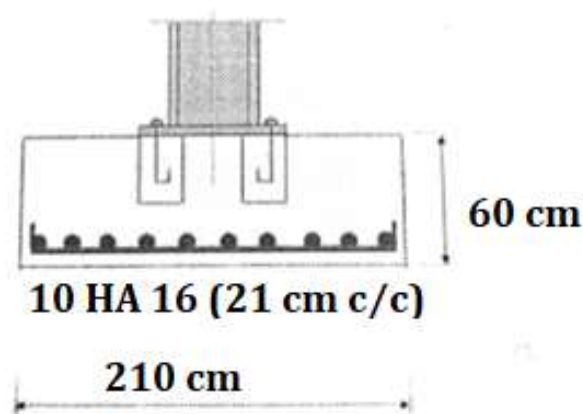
le ferrailage et armature principale des semelles transversales
